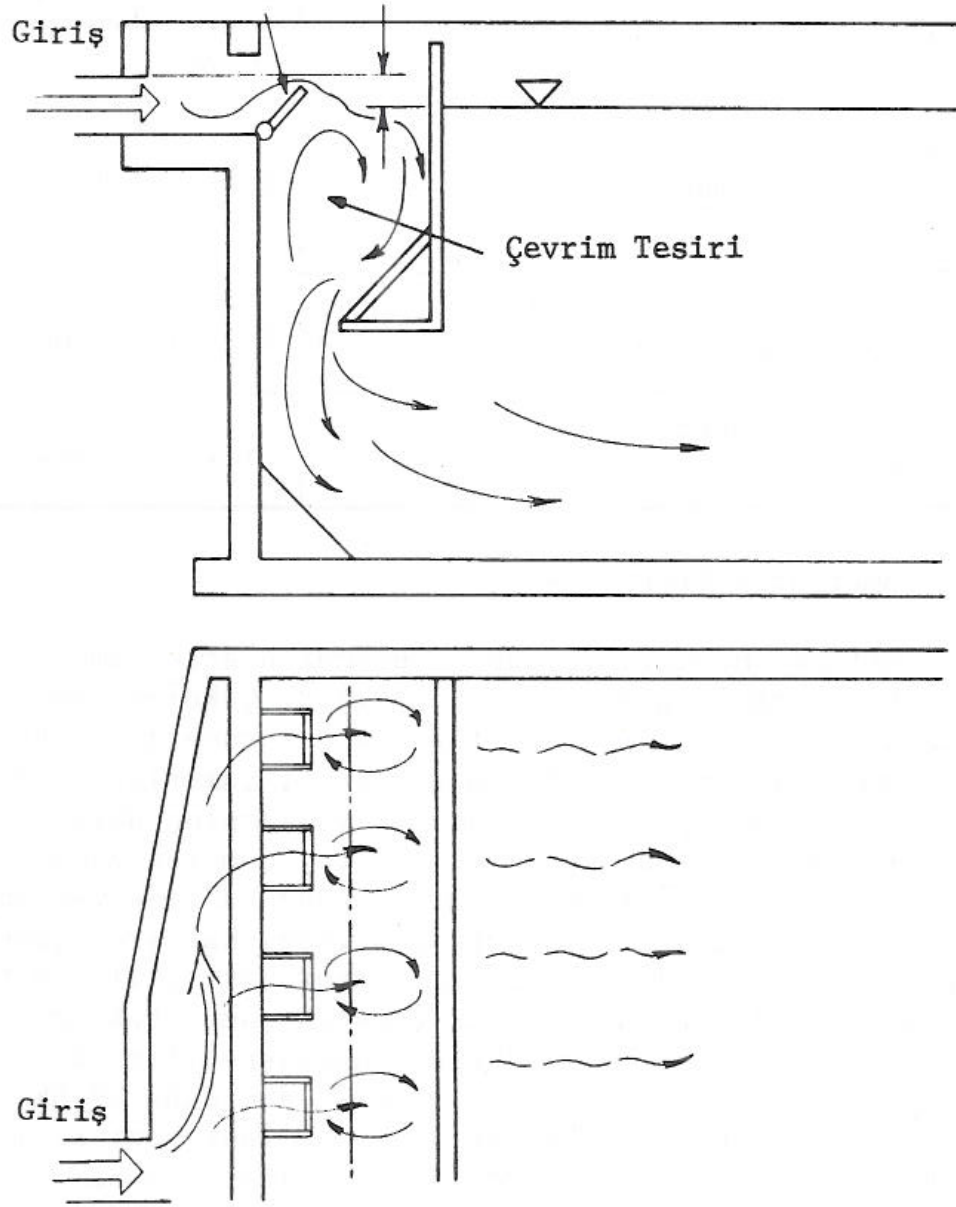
Çökeltme Havuzu Giriş Yapıları
